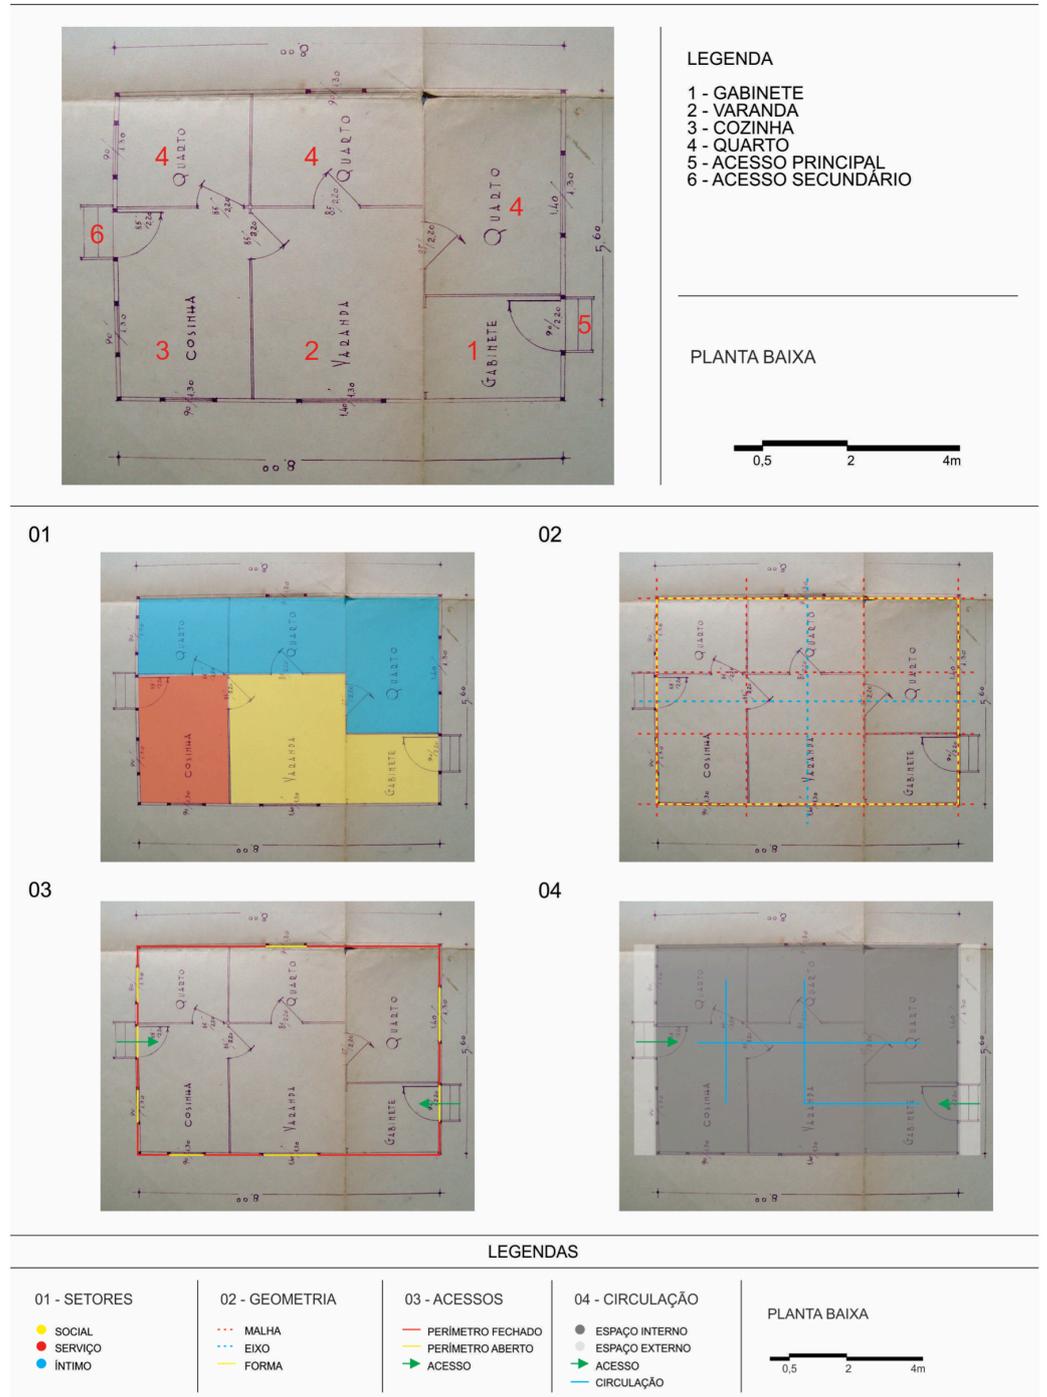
Análise da planta baixa da casa Modelo nº2 da CAPFESP, 1947. Fonte: Arquivos do INSS/RS, 2019 (adaptação própria).
